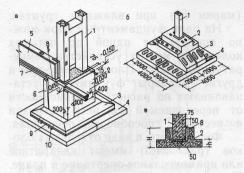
Сборные железобетонные фундаменты и опирание на них колони каркаса
